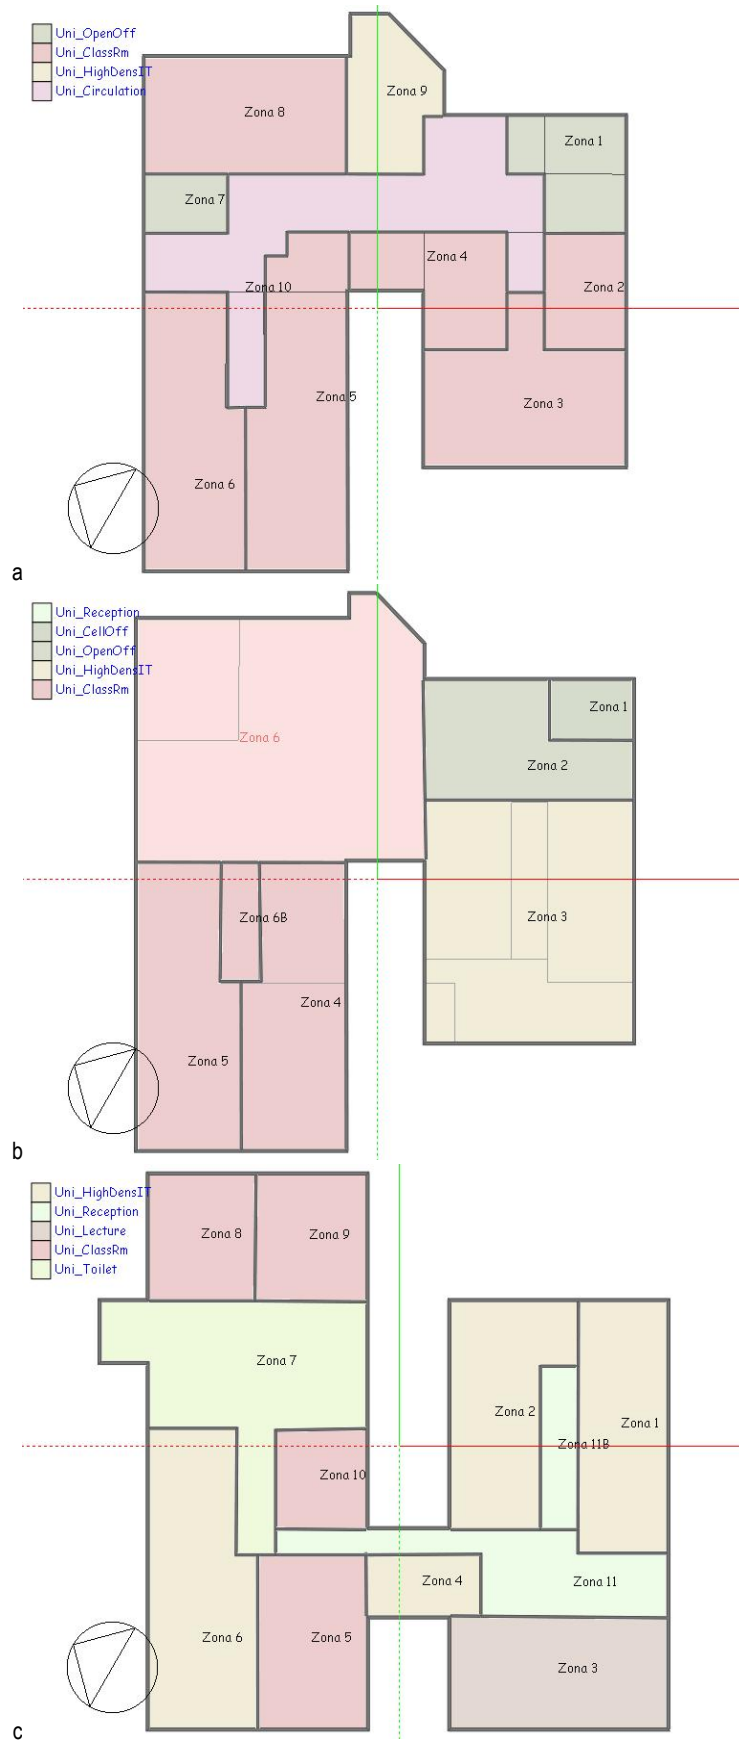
Multi-zonas térmicas edificio G1 *DesignBuilder*: a. 2ª planta; b. planta baja; c. sótano.
